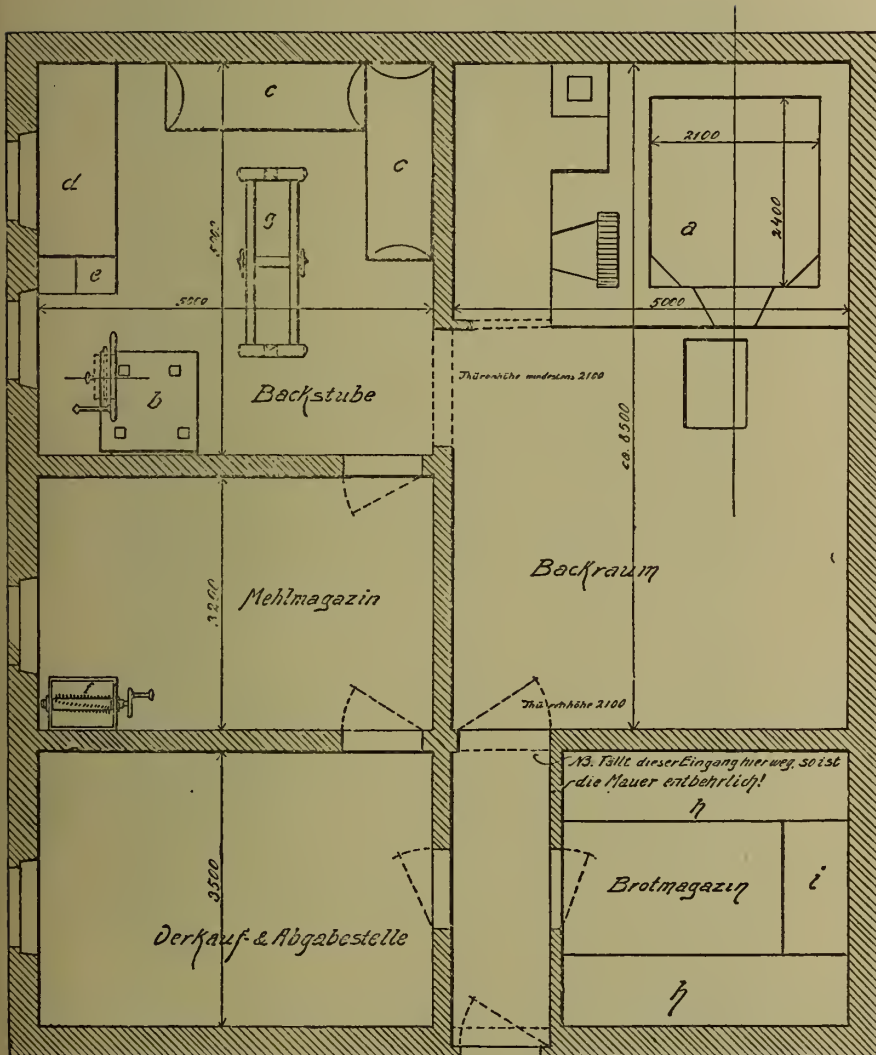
Grundriß einer Bäckerei mittleren Umfanges mit Maschinenbetrieb.
